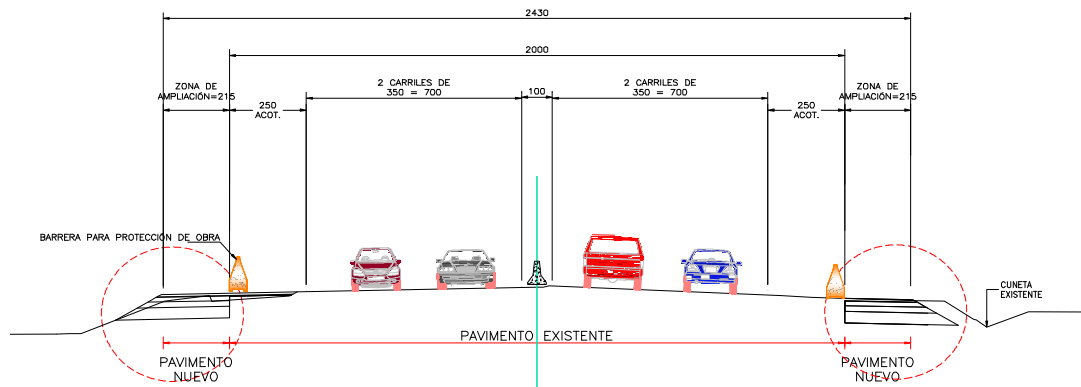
Sección transversal de la autopista considerando la ampliación transversal. (Fuente: plano de planta general de proyecto)
